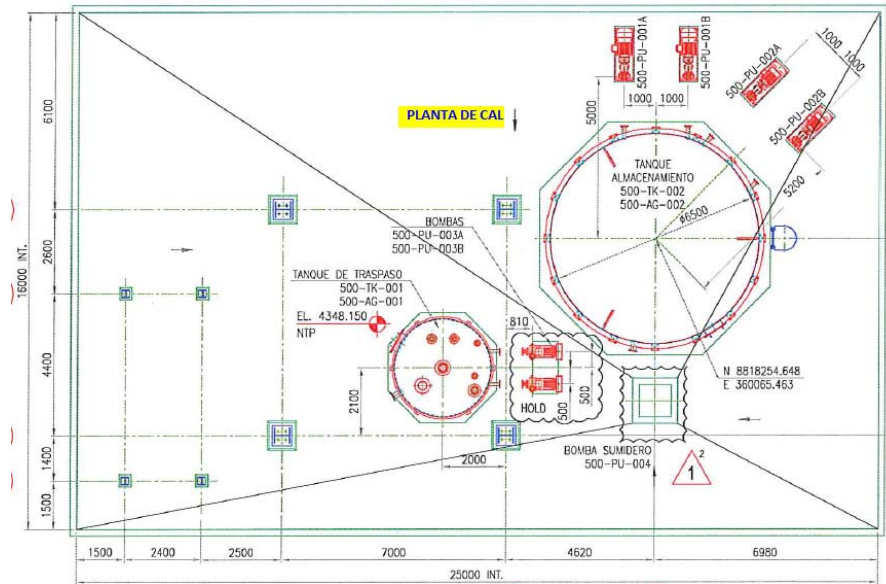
Zona de la Planta de Cal (Fuente: Empresa consultora ABC)
